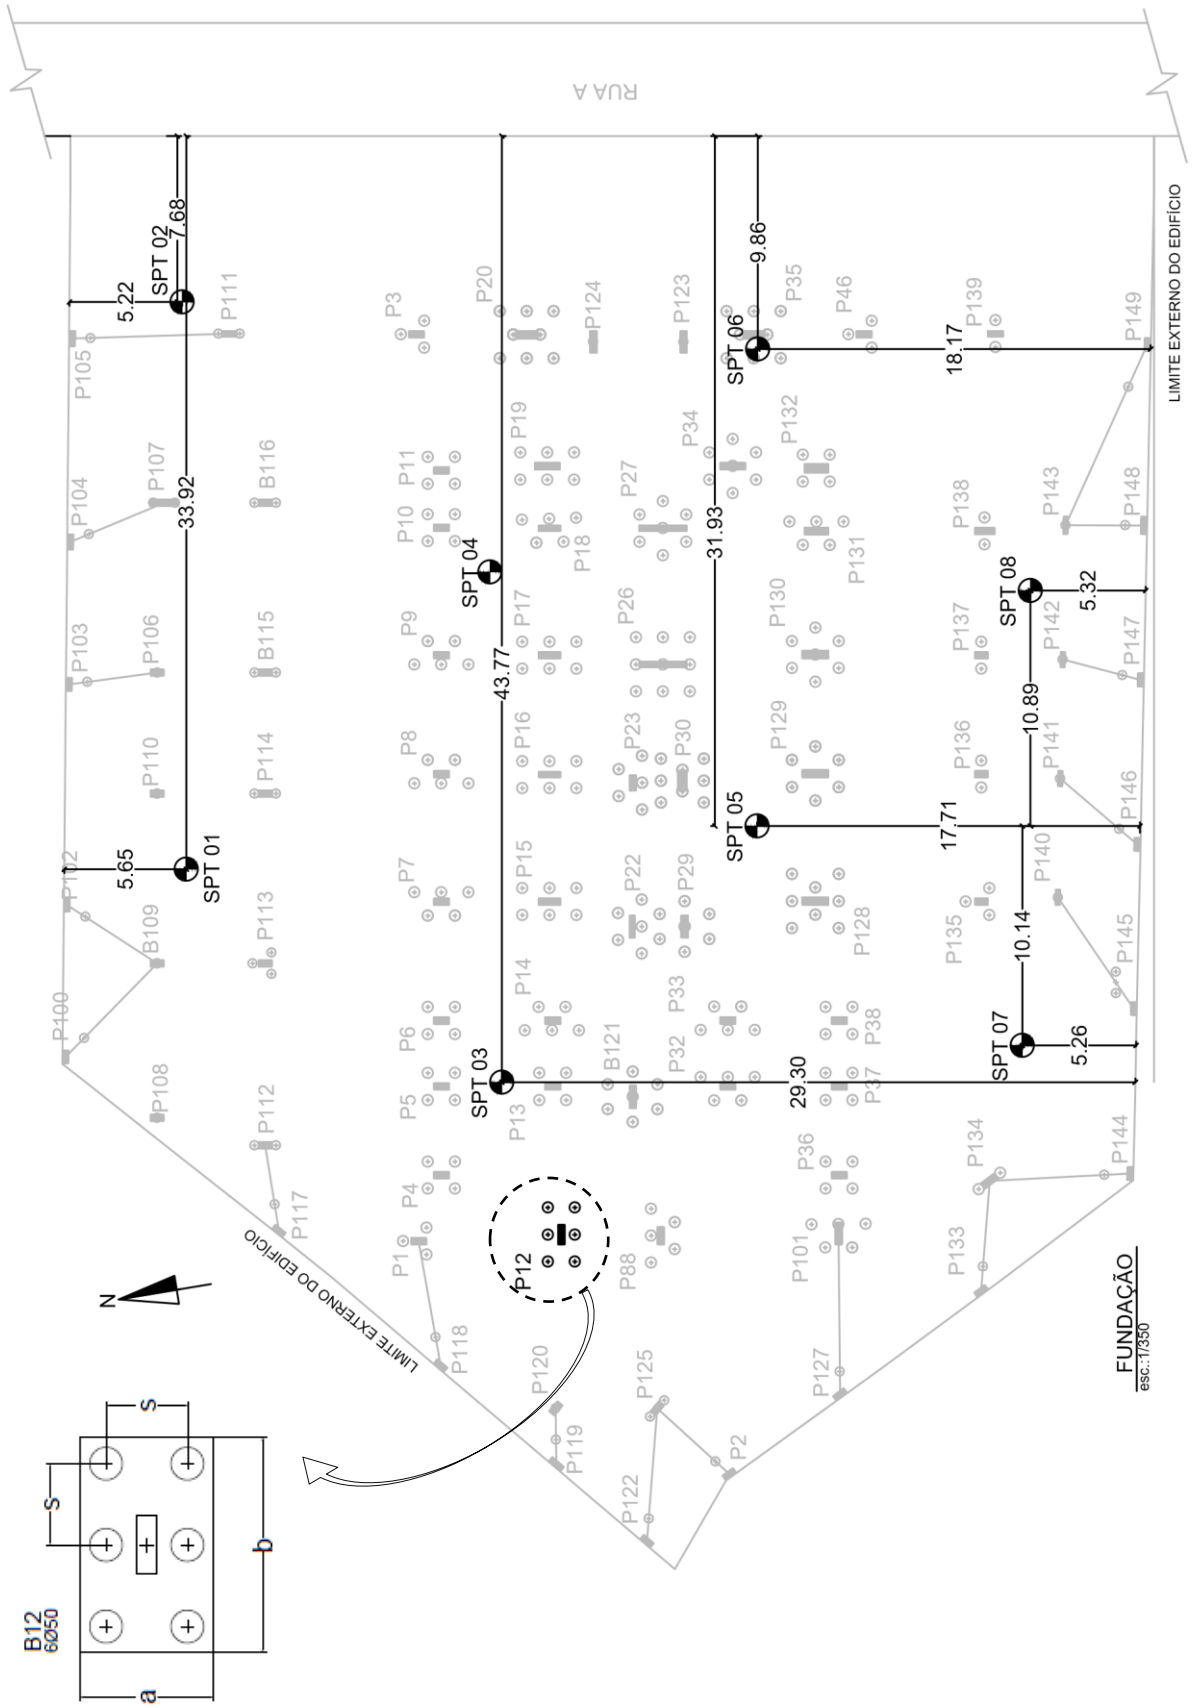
Planta de fundação, localização dos furos de sondagem e detalhes do bloco B12
